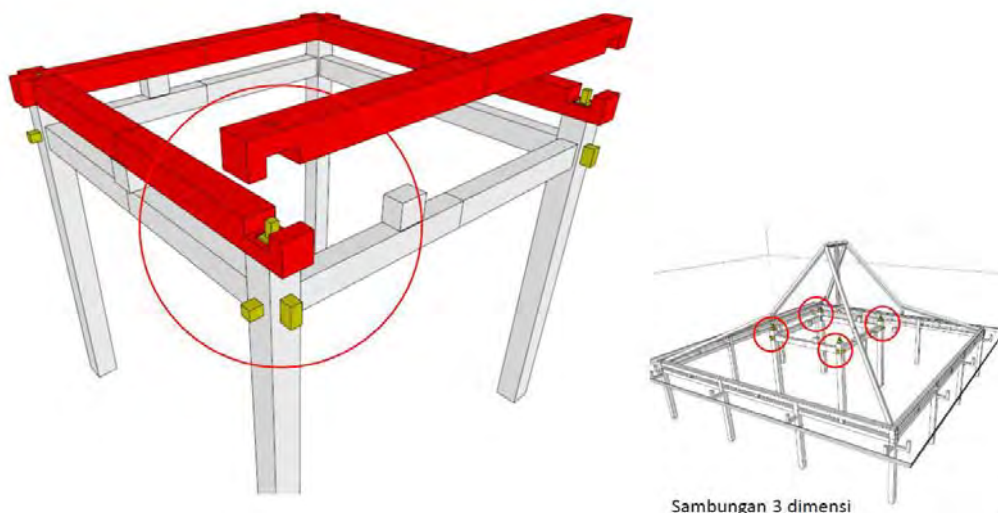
Sambungan kolom dan balok utama dan balok tepi pada arsitektur Joglo (kiri) dan sambungan kolom dengan balok tepi dan balok lantai (kanan).
